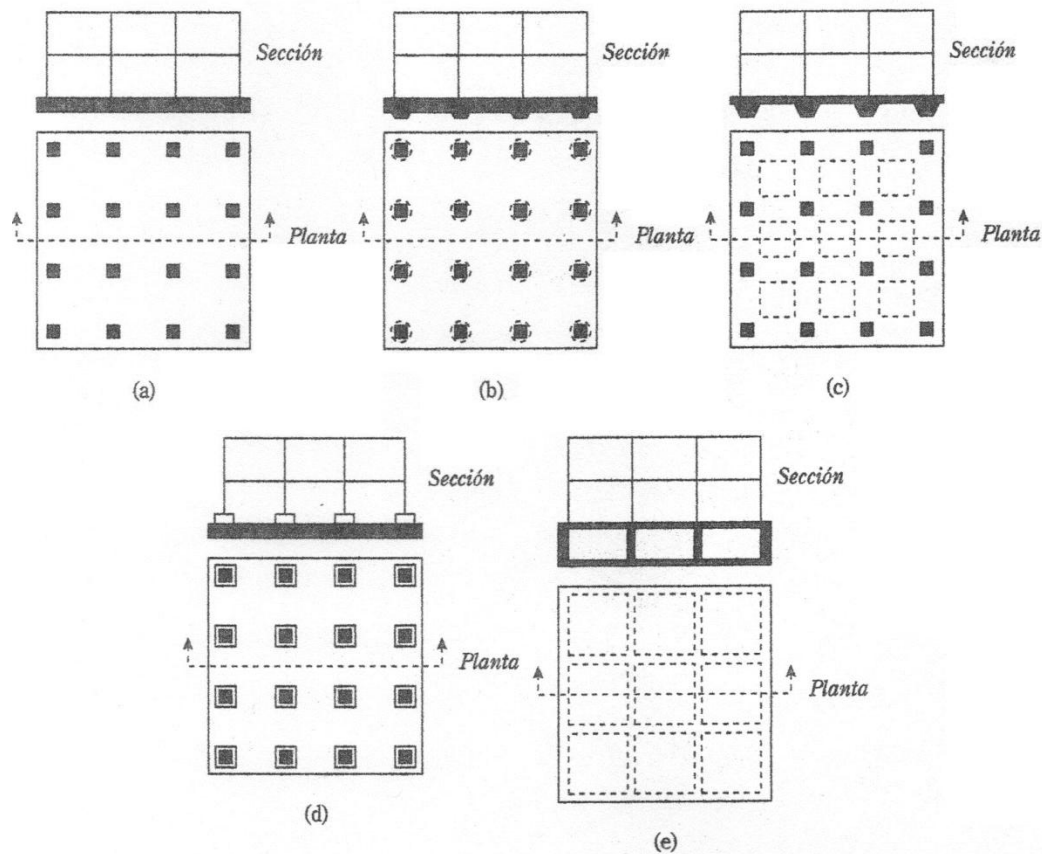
Tipos comunes de losas de cimentación, la figura (e) corresponde a una losa con muretes integrados para sótano o cajón de cimentación, los muretes trabajan como atiesadores de la losa (Braja M. Das, 2006).
